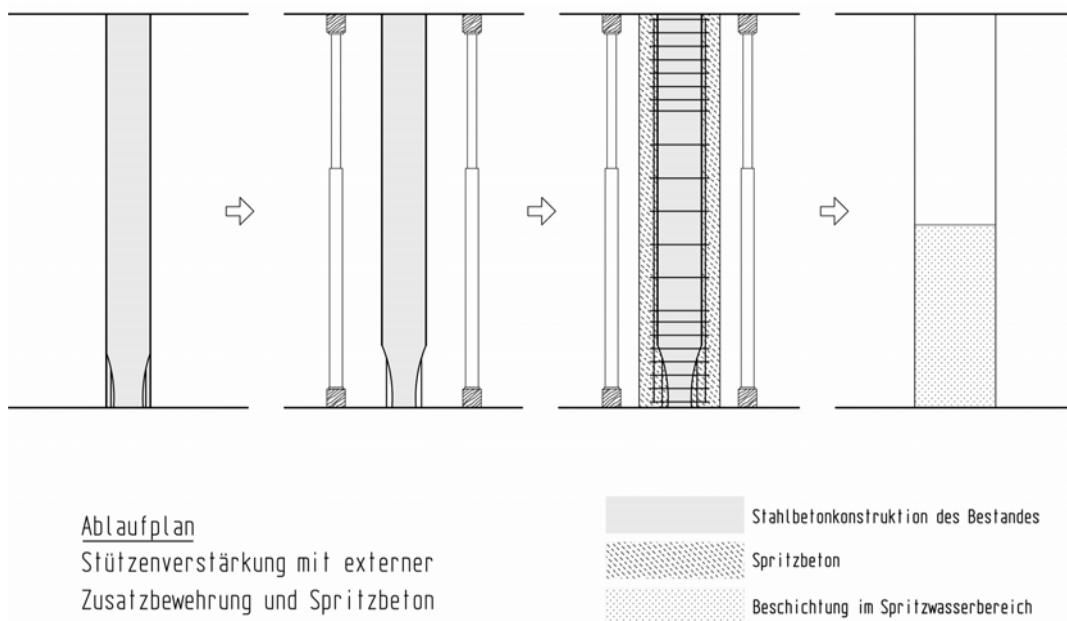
Stützenverstärkung mit externer Zusatzbewehrung und Spritzbeton
